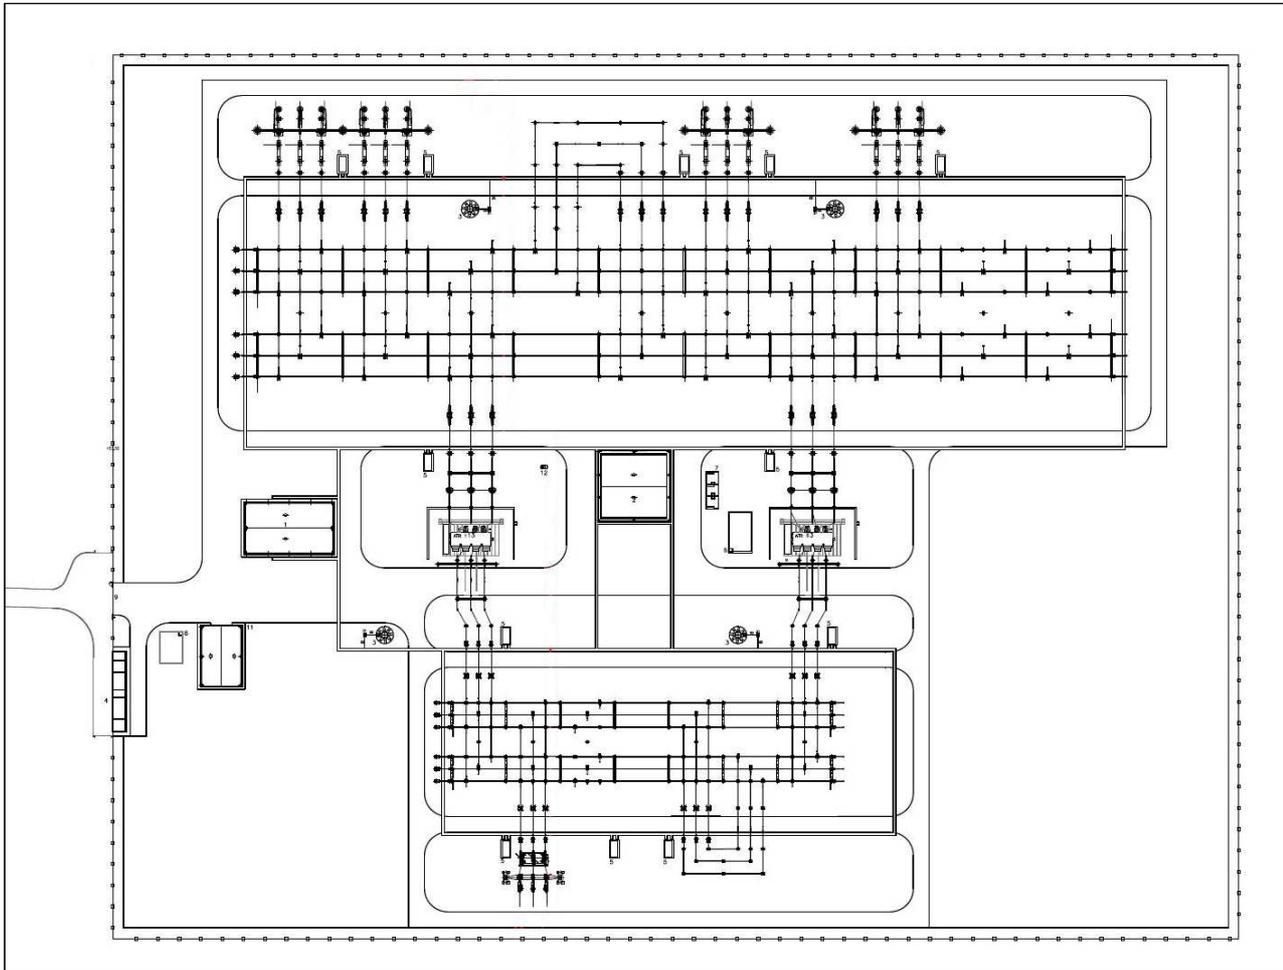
Planimetria elettromeccanica della S.E. 380/220 kV di Udine Sud
